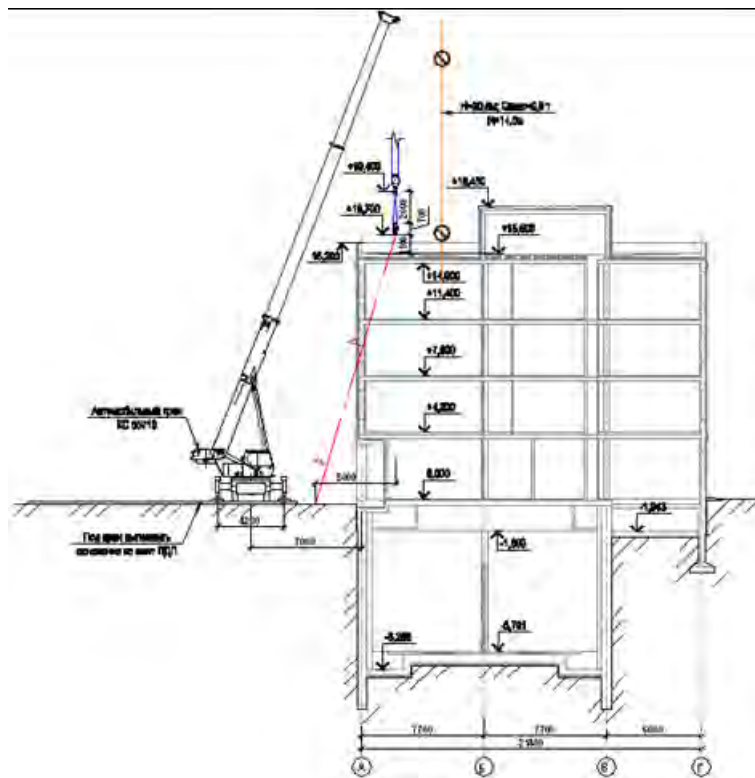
Расчет опасной зоны от падения груза (при перемещении краном)
